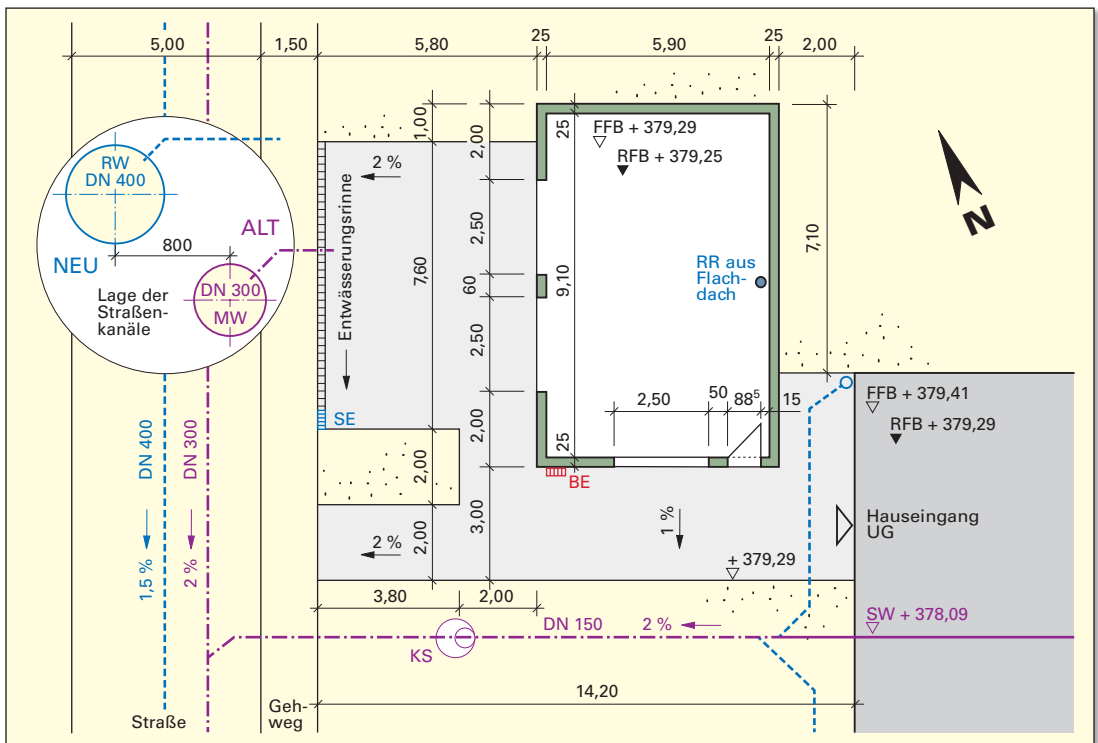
Garagen, Hauszugang, Entwässerung (Planung)
